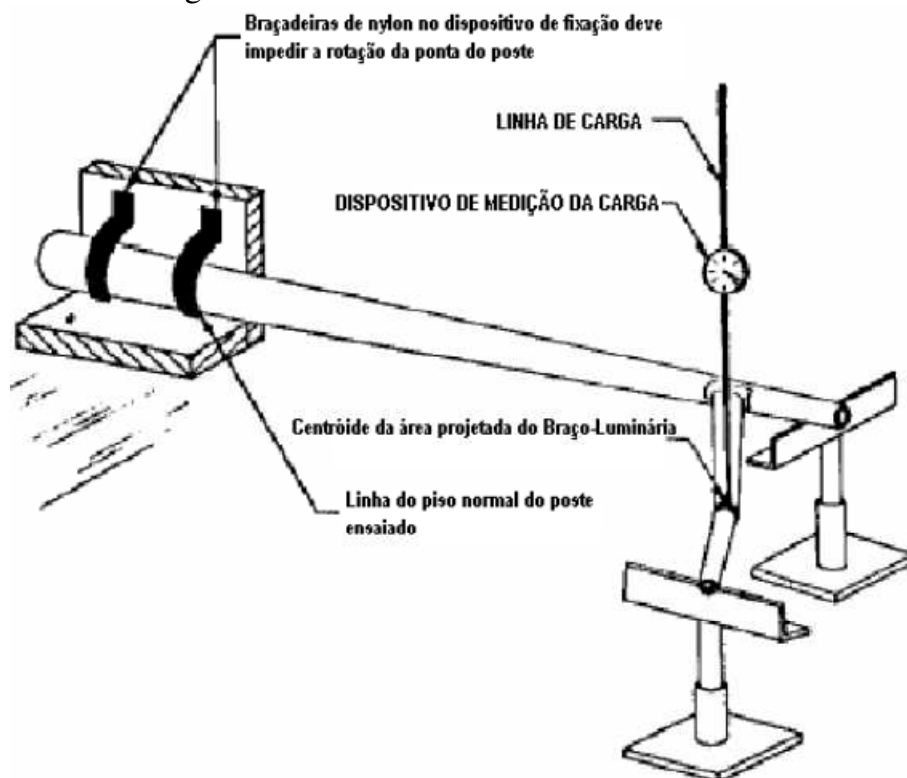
Dispositivo de ensaio torsional para postes com engastamento
